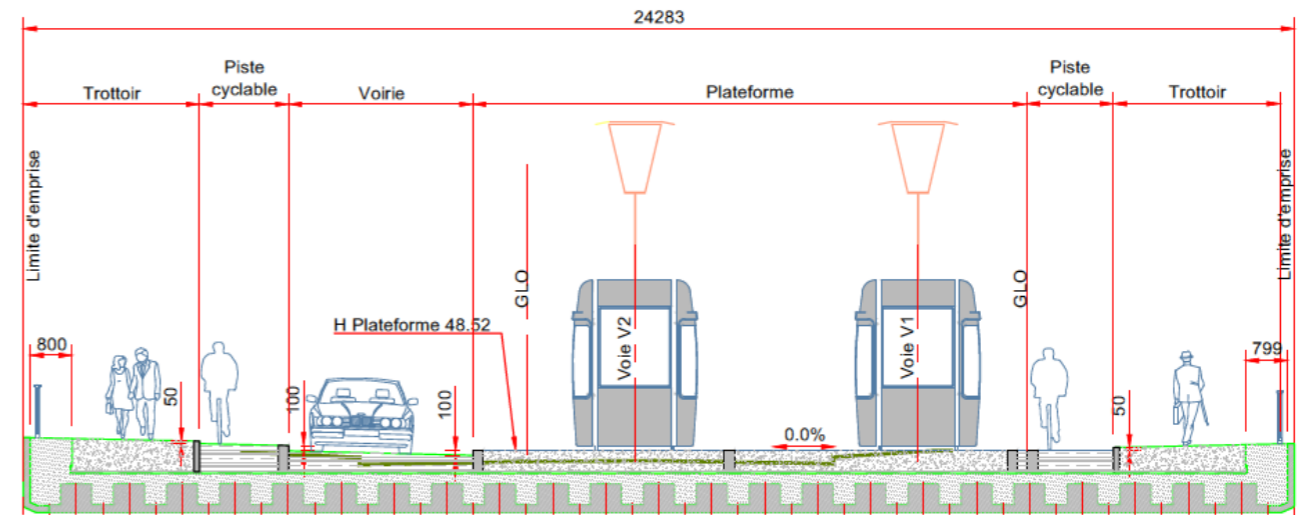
coupe transversale fonctionnelle sur ouvrage
